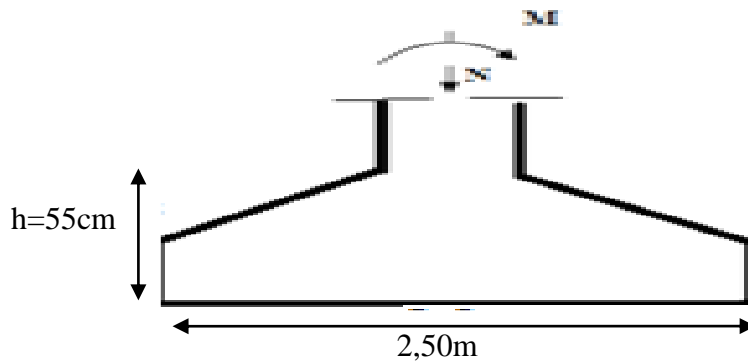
Coupe type semelle isolée S2 (2,50x2,50)
